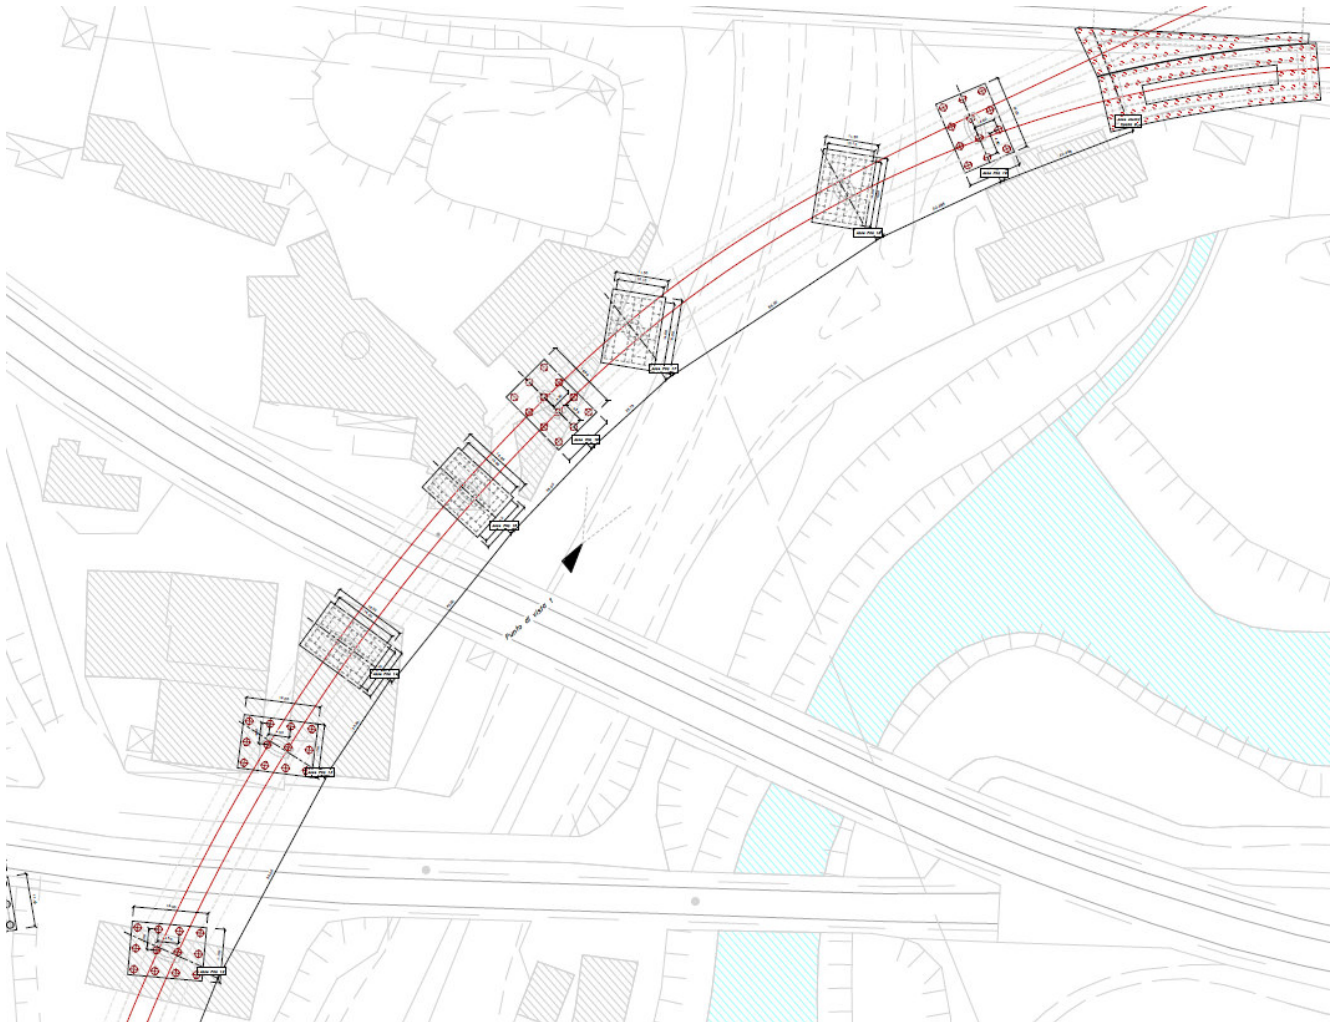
Pianta fondazioni - Ponte a struttura mista acciaio calcestruzzo a doppio binario
